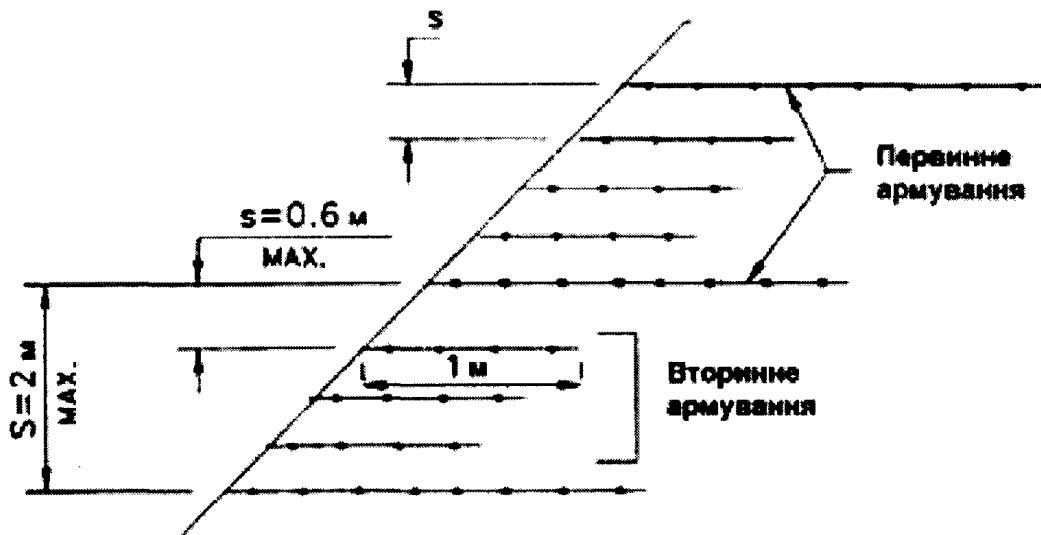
Схема закладання полотен вторинного армування між полотнами первинного армування
